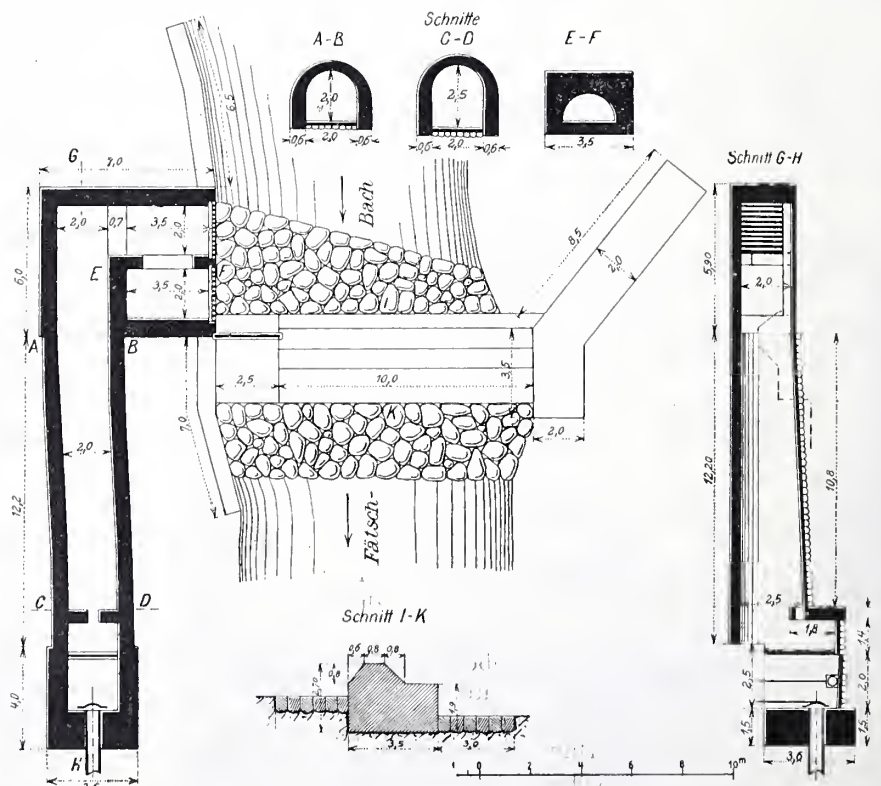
Die Wasserfassungsanlage. Grundriss und Schnitte. — Masstab 1 : 300.
